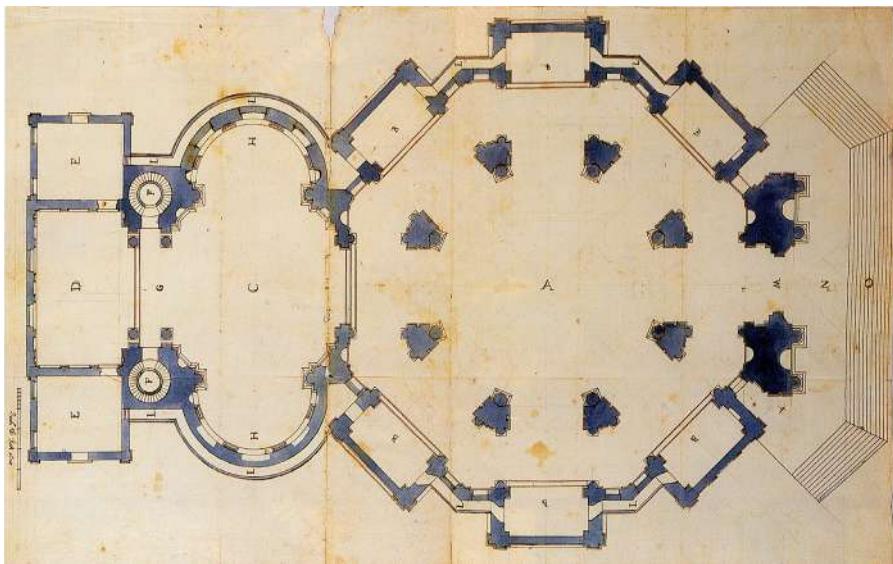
Baldassarre Longhena, pianta di Santa Maria della Salute (ante 1634). Archivio parrocchiale di Santa Maria in Vallicella, Roma.
